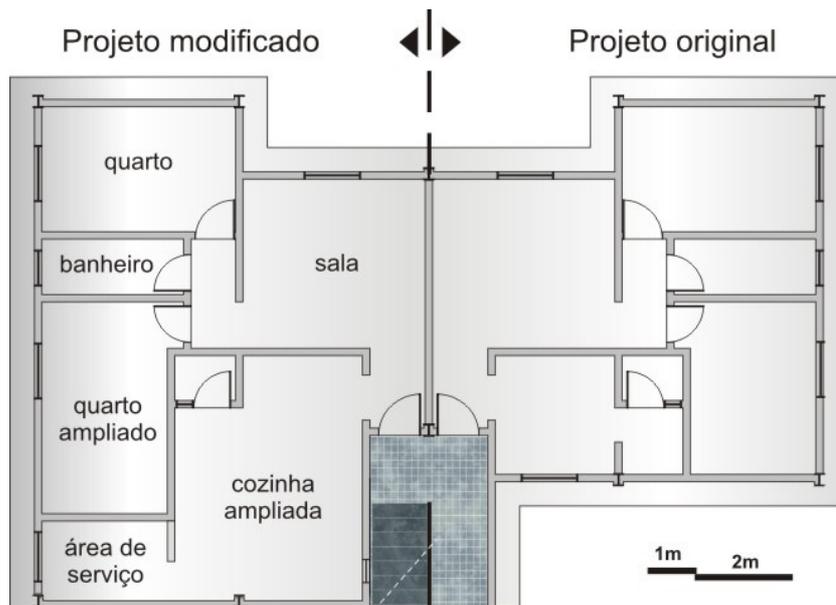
Edifício 3115 – Planta do projeto modificado x projeto original
